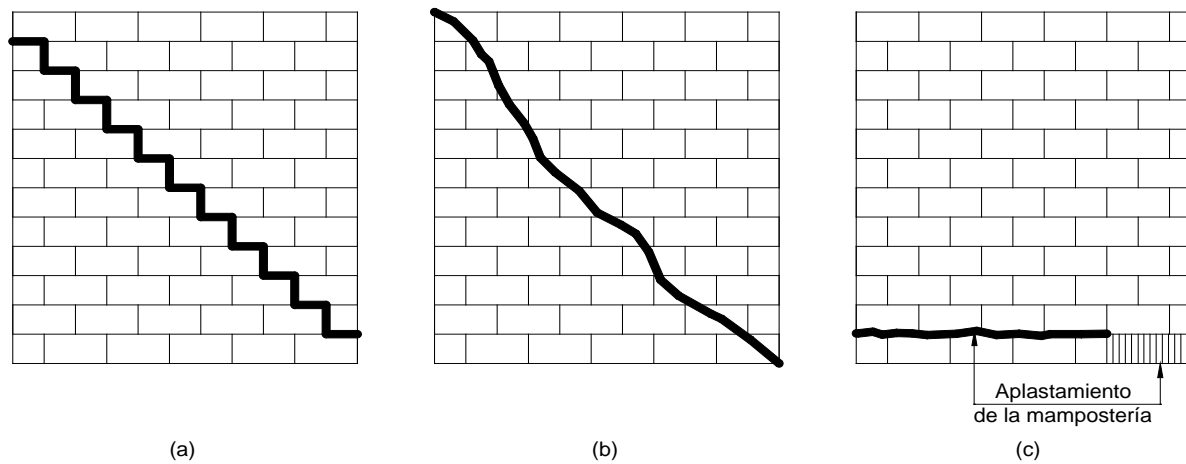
Modos de falla de la mampostería no reforzada sometida a cargas en su plano.
